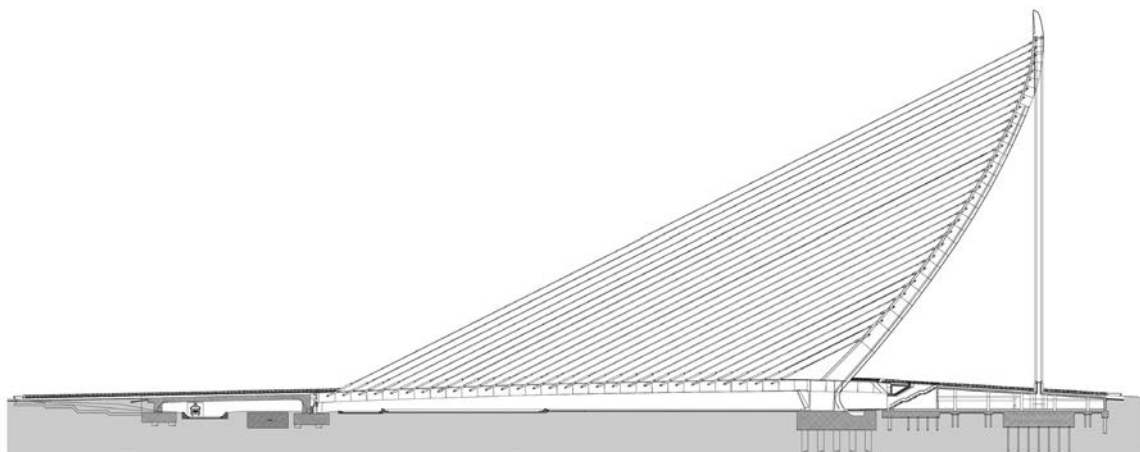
Alzado de puente, vanos de acceso y cimentaciones.
